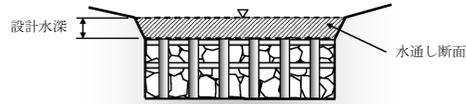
水通し断面 (斜線部) 『土・対・針 P32』『鋼・砂・便 P93』
